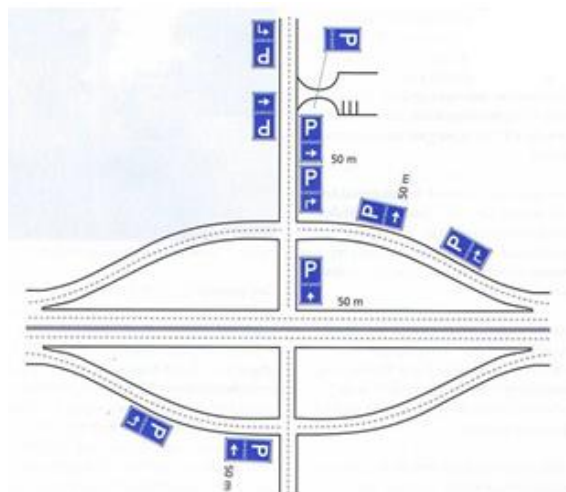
Exemple typique d'un parking de covoiturage bien accessible à la multimodalité
